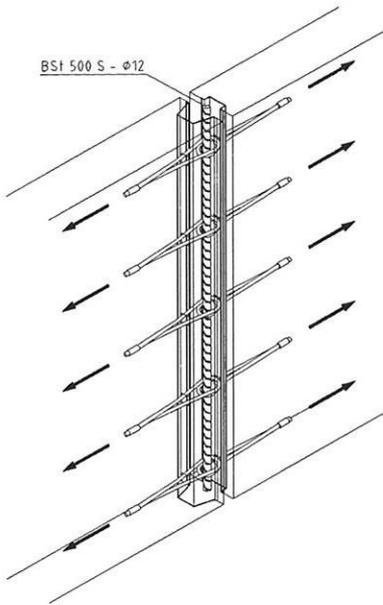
Zugbeanspruchung in Schlaufenlängsrichtung
